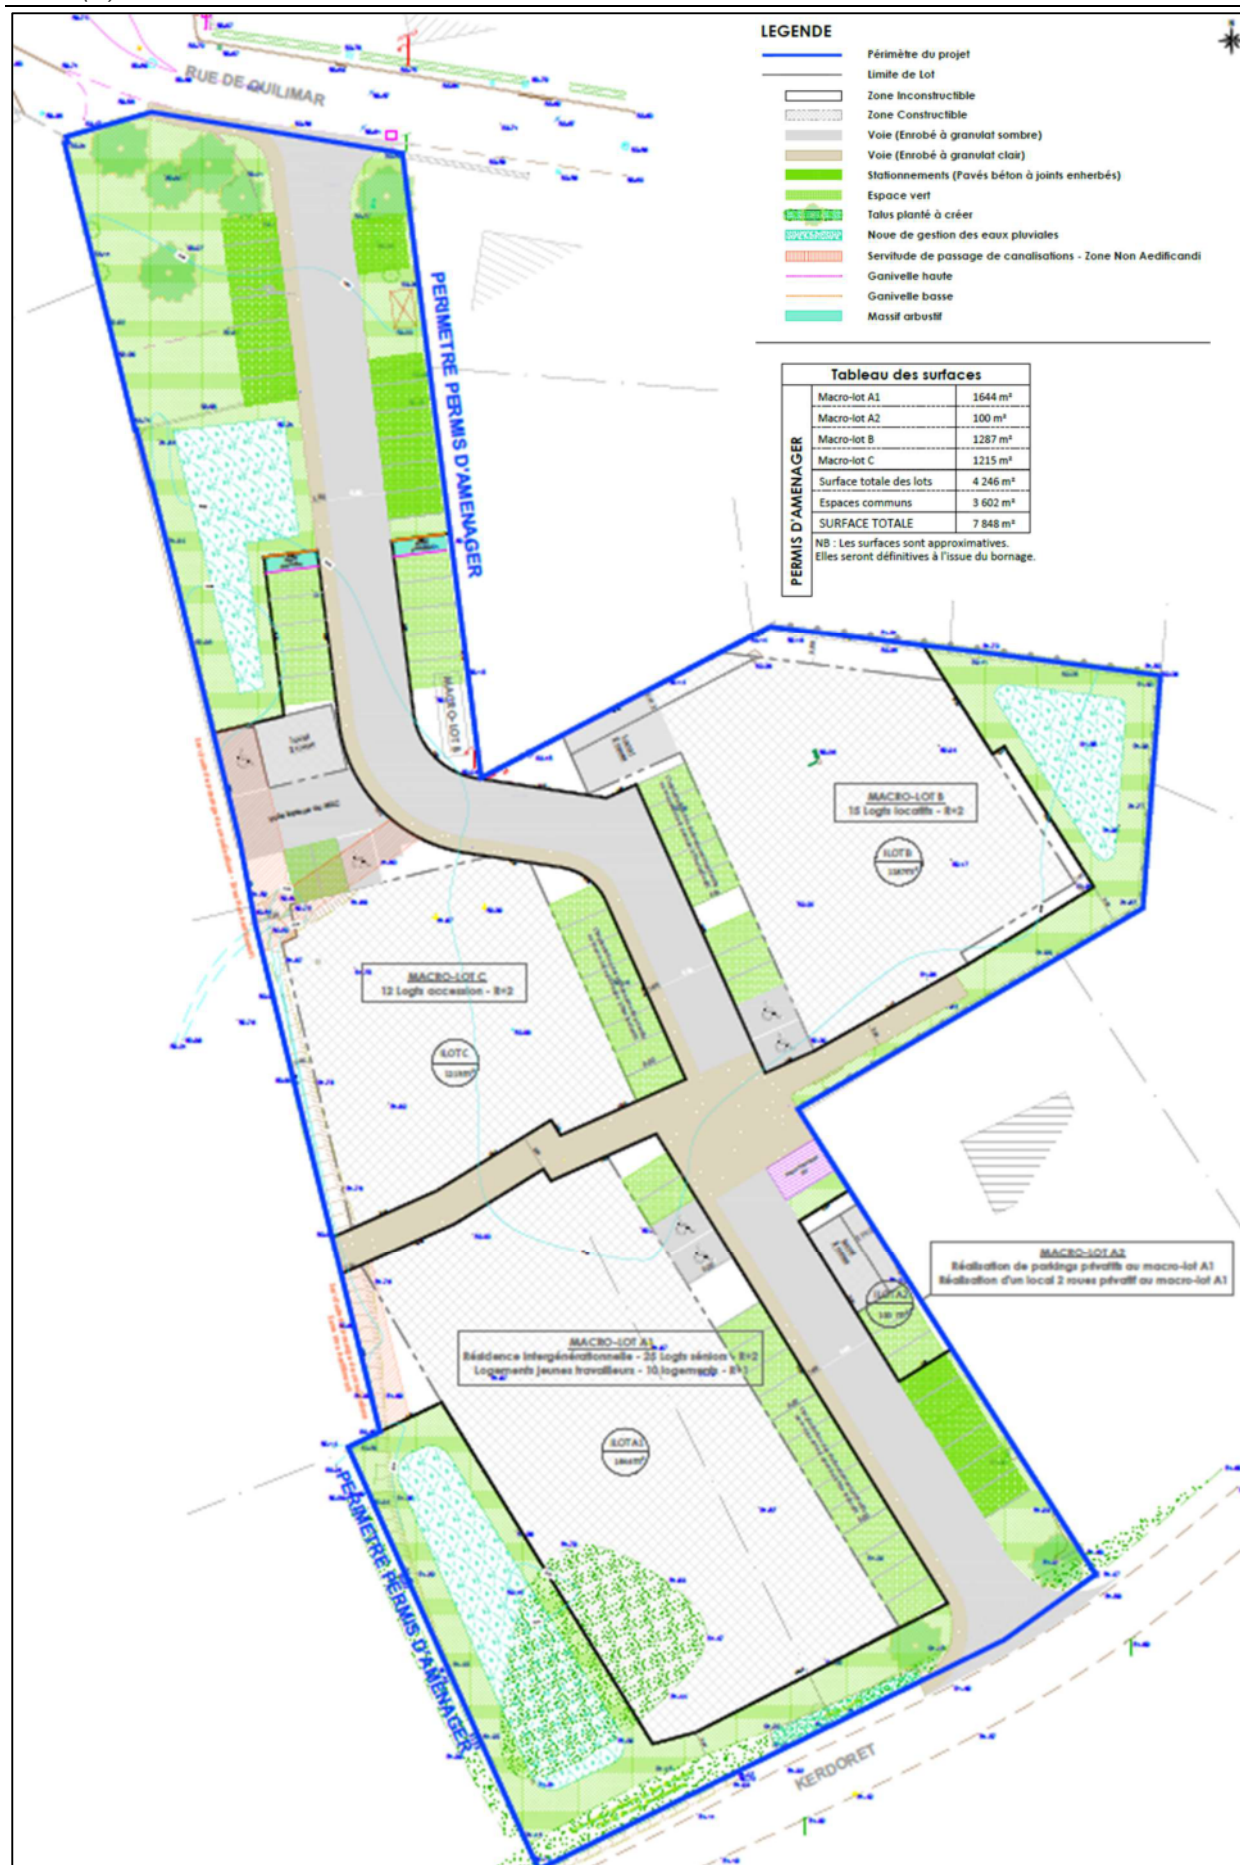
Plan de composition (source : Aiguillon Construction, juin 2024)
